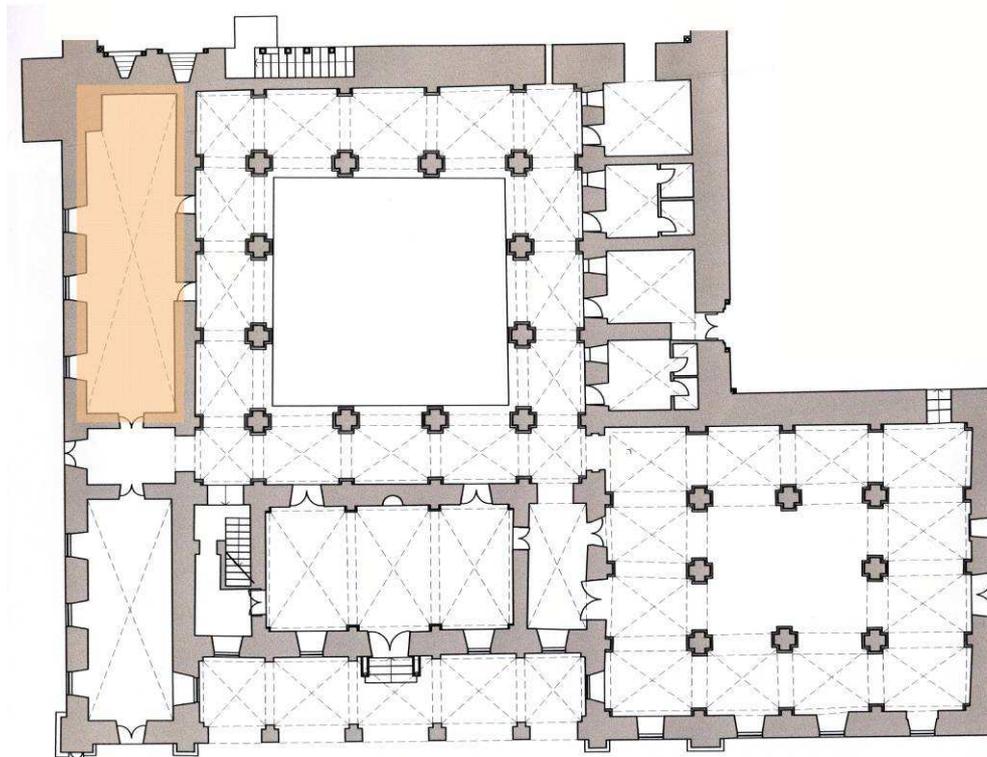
Localização da sala da galeria Norte na planta do piso térreo do levantamento de 2003.
